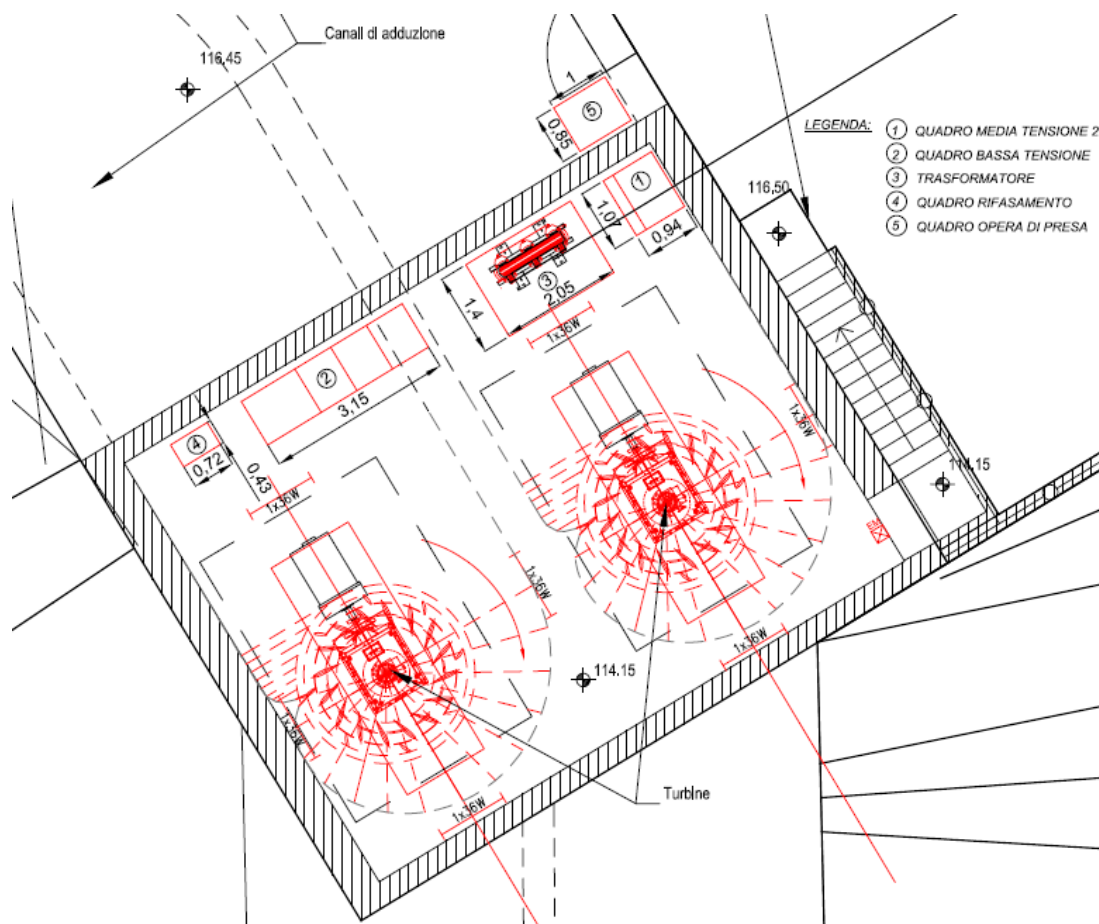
LAYOUT ELETTRICO DI IMPIANTO
